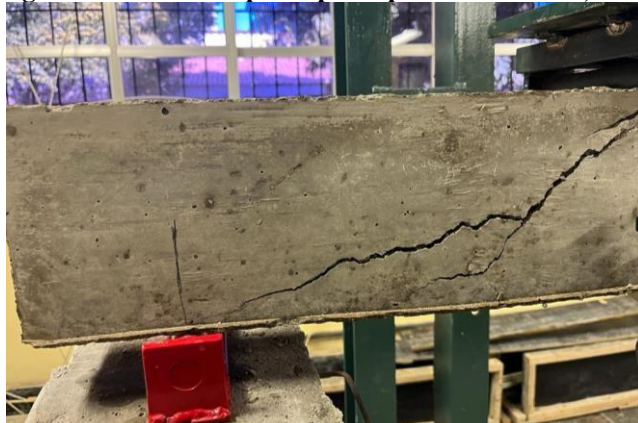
Fissuras após ruptura por cisalhamento, V1A.
